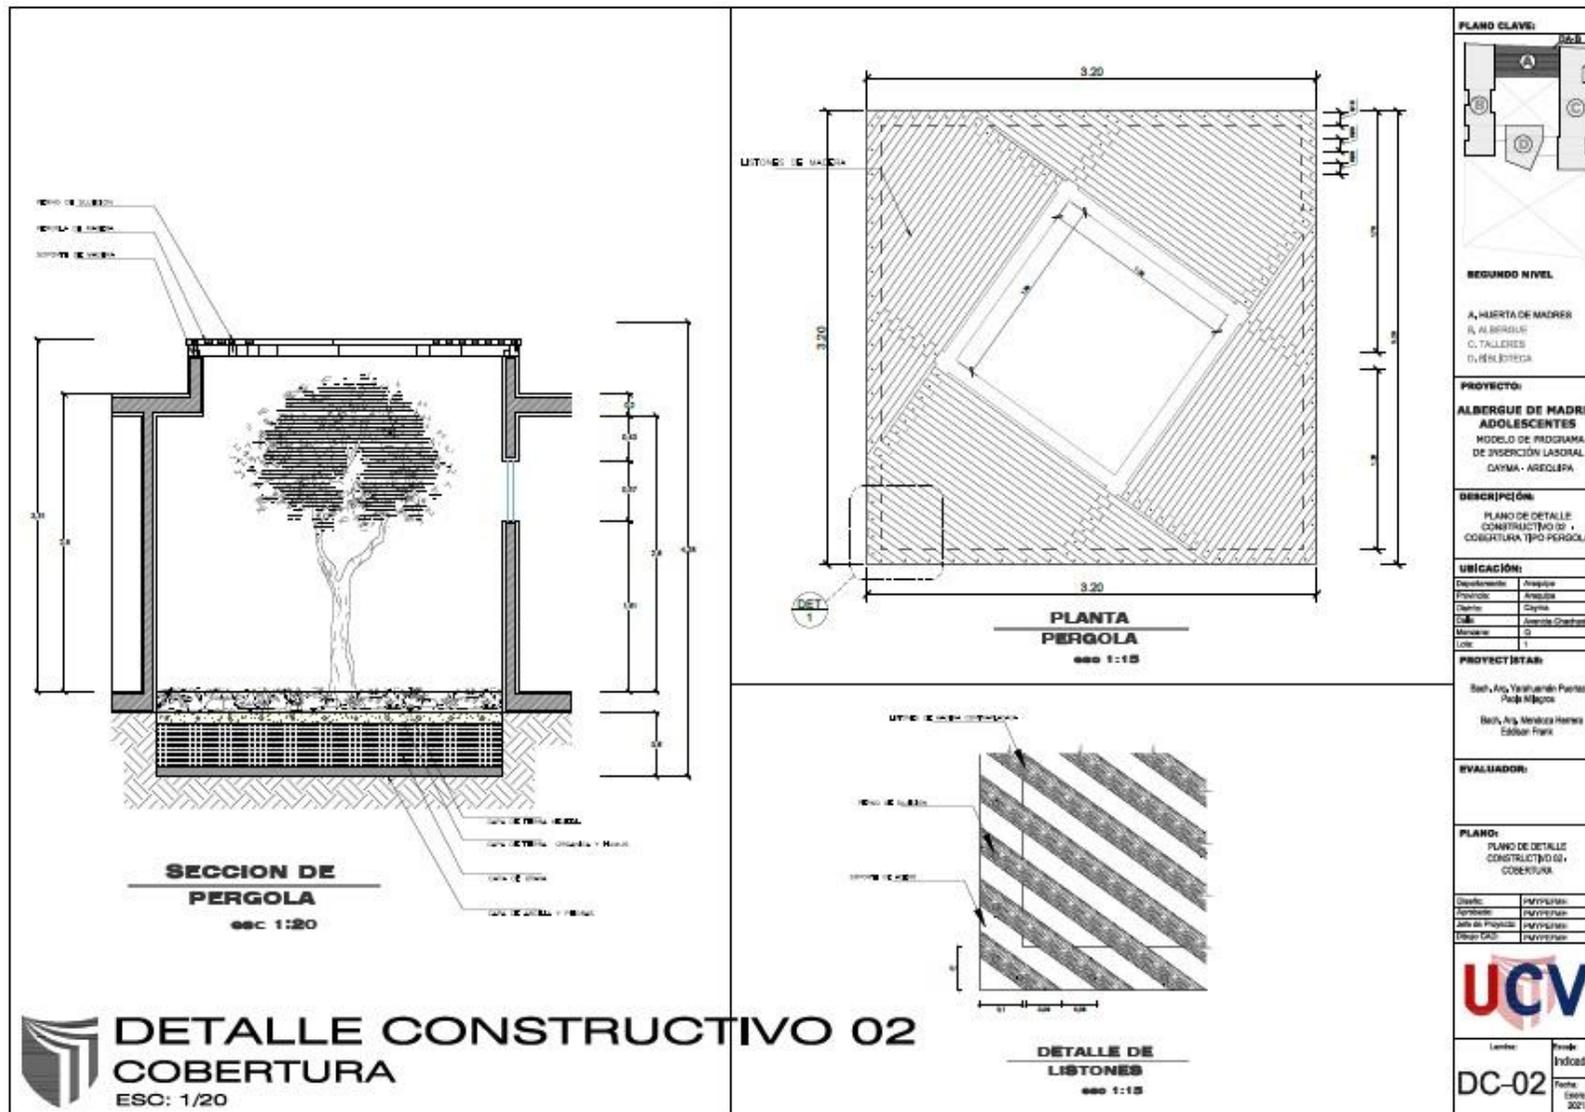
Detalle Constructivo 02 – Cobertura de zona Exterior de Aula en Cuna Jardín DC-02.
